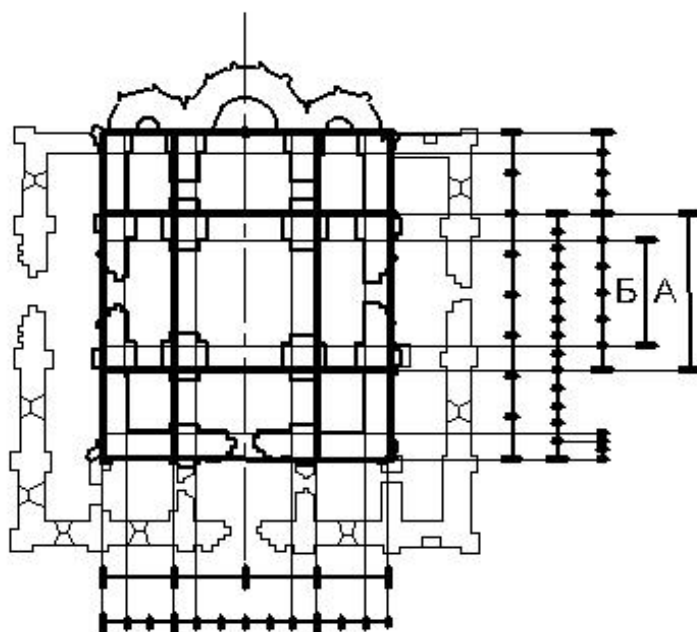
Разбивка плана на строительной площадке и определение дополнительных размеров.
